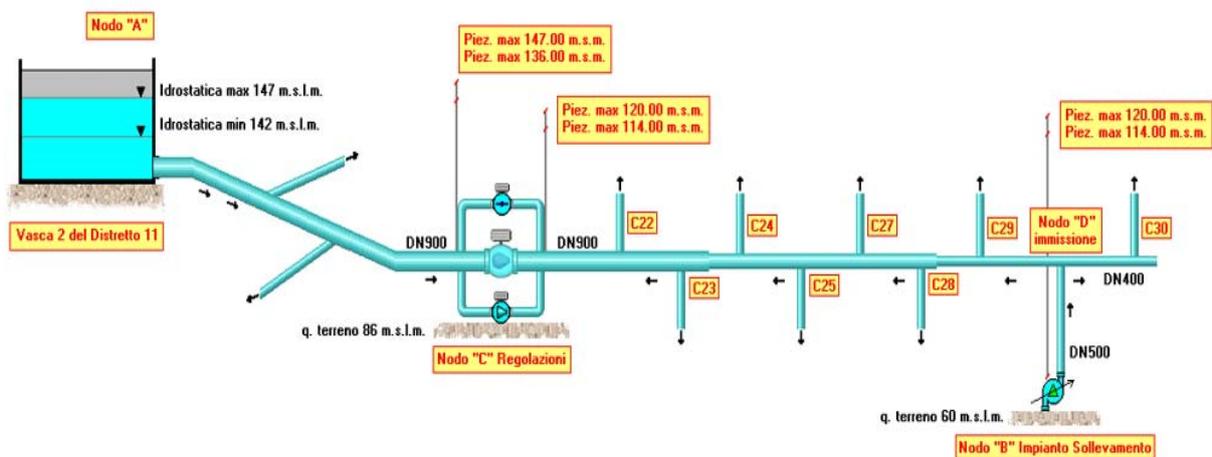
Schema idraulico del sistema di adduzione Distretto 11
